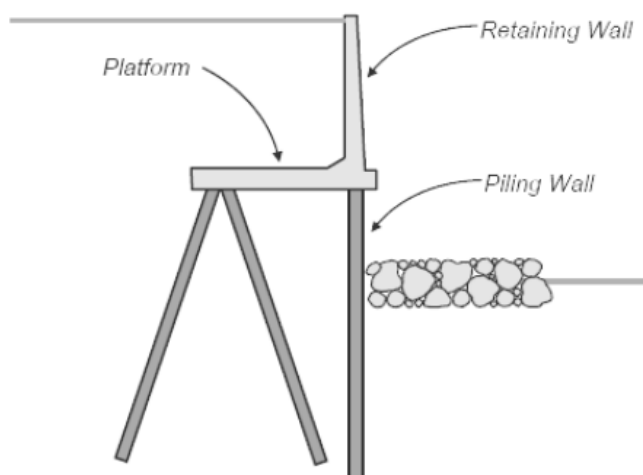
เขื่อนป้องกันตลิ่งแบบ Sheet-Piling Wall รูปแบบต่าง ๆ
